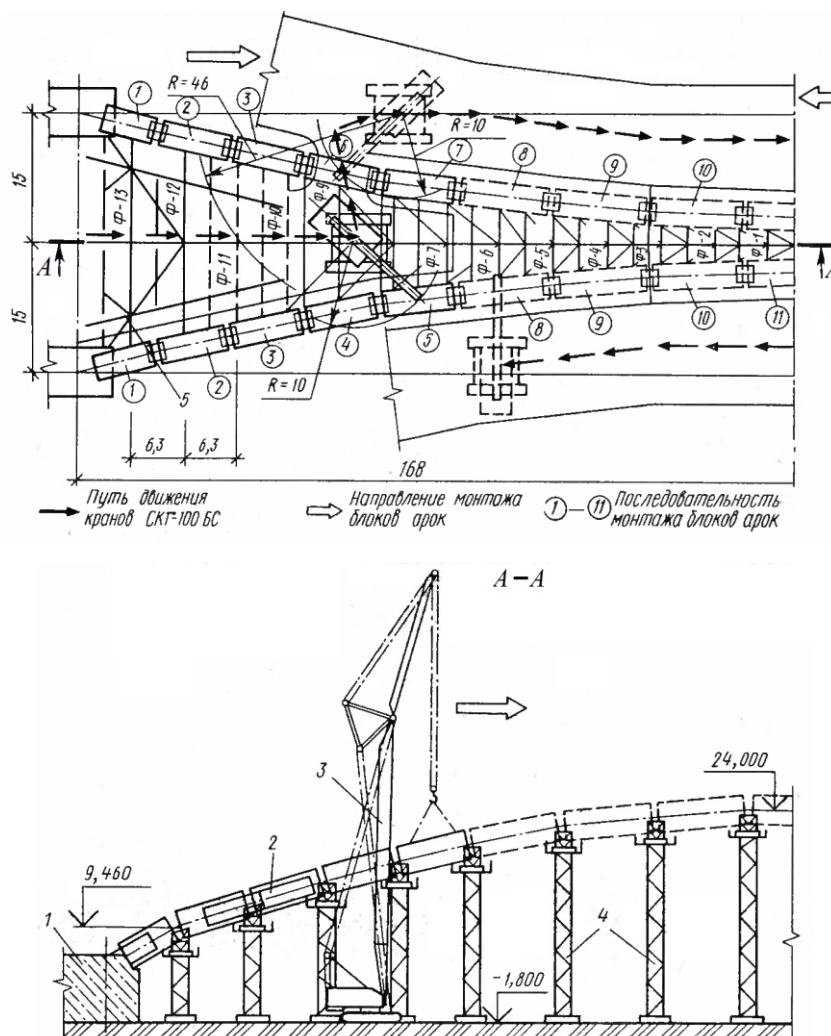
Схема монтажа внутренних арок покрытия велотрека:
